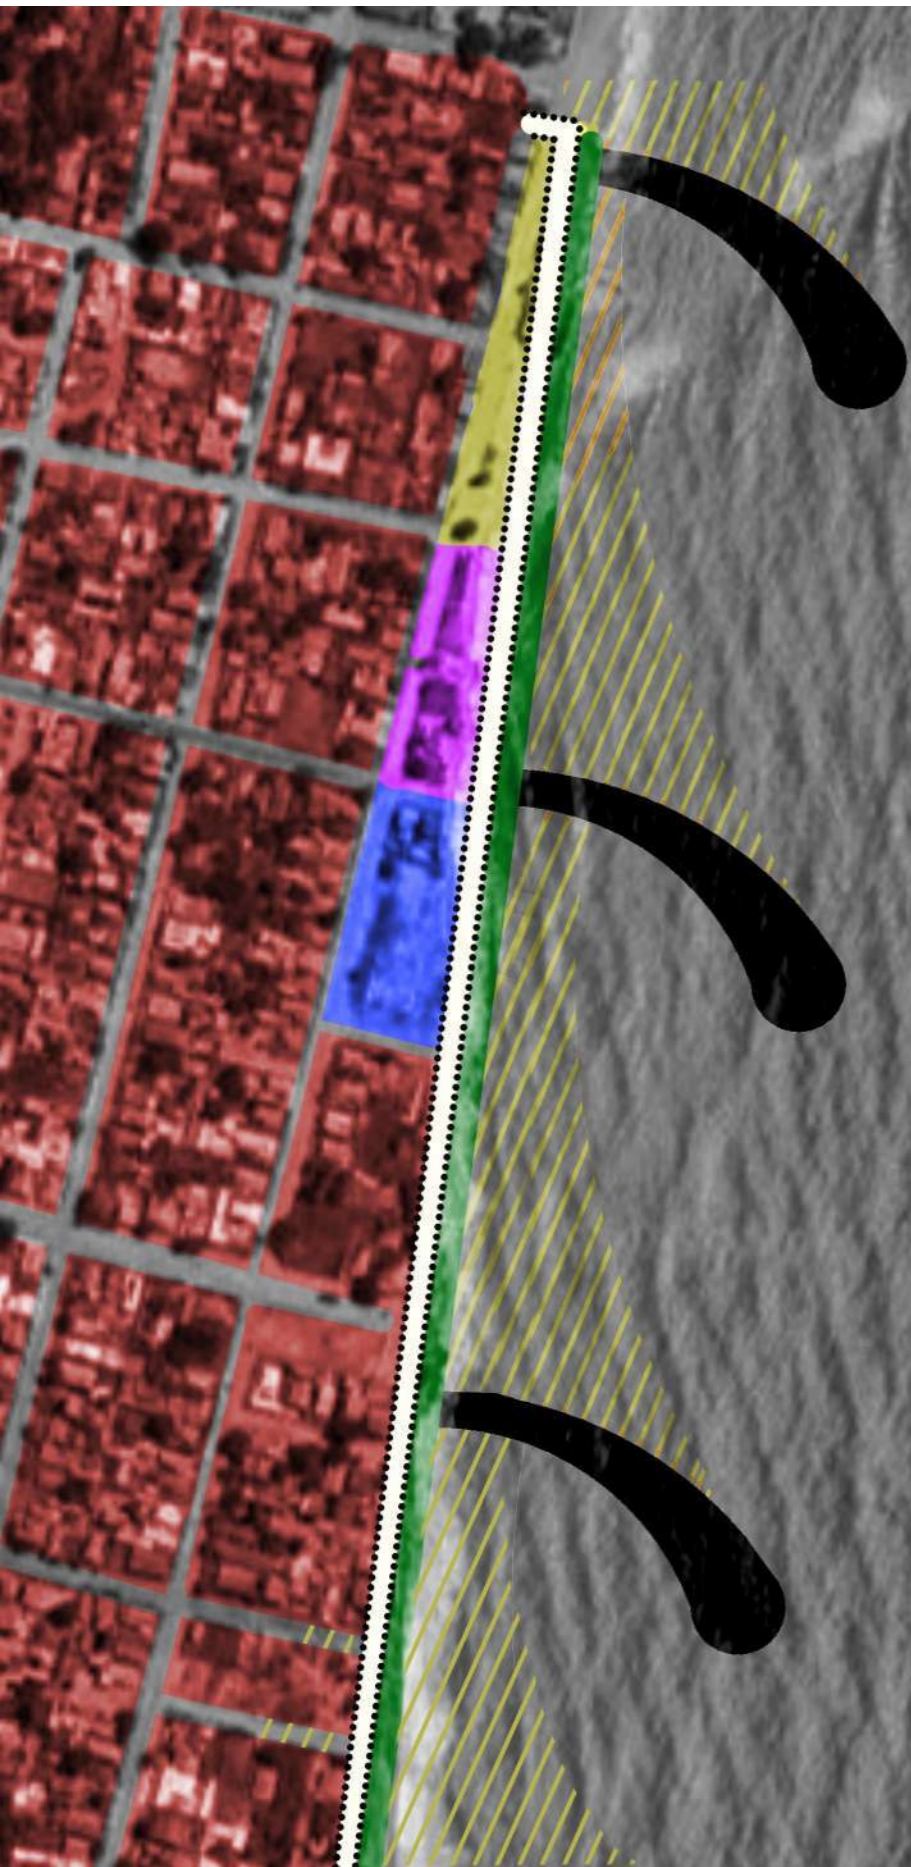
Planta e corte do modelo de espigão a ser instalado ao longo da praia de Atafona
